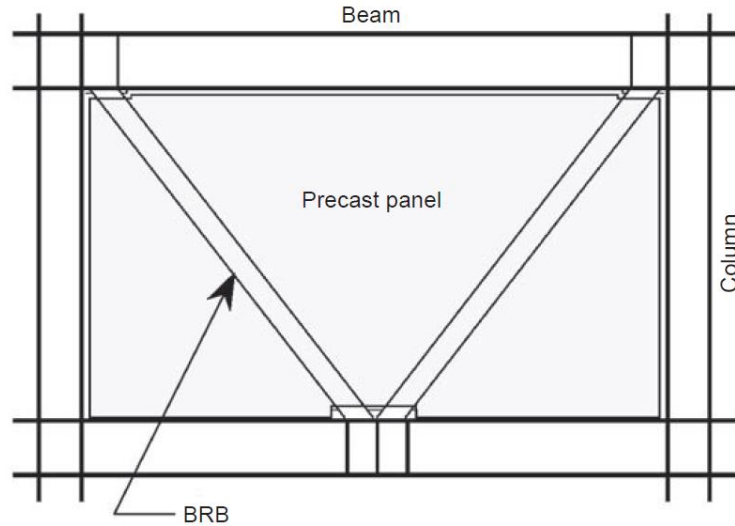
Barras *BRB* confinados por paneles de hormigón prefabricado [25]
